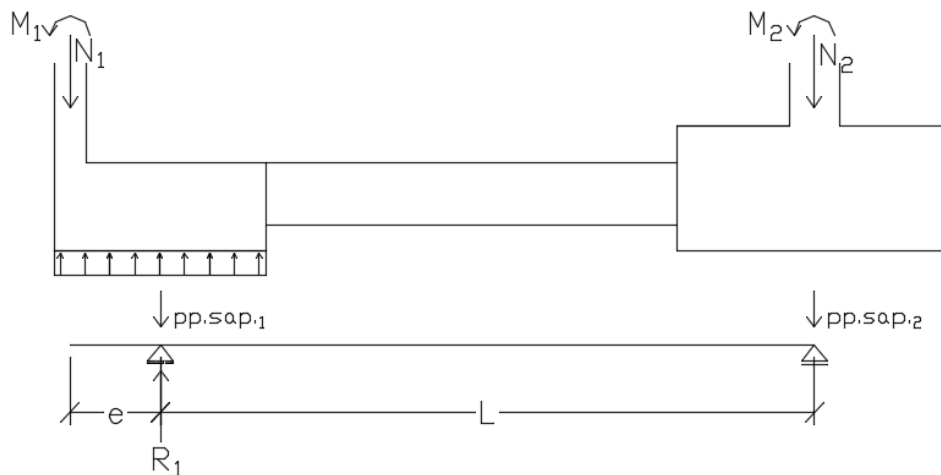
Esquema de sapatas com cargas excêntricas interligadas com vigas de fundação
